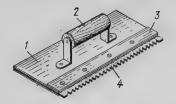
1 — полотно рабочее; 2 — держатель — обойма; 3 тулейка; 4 — ричка
